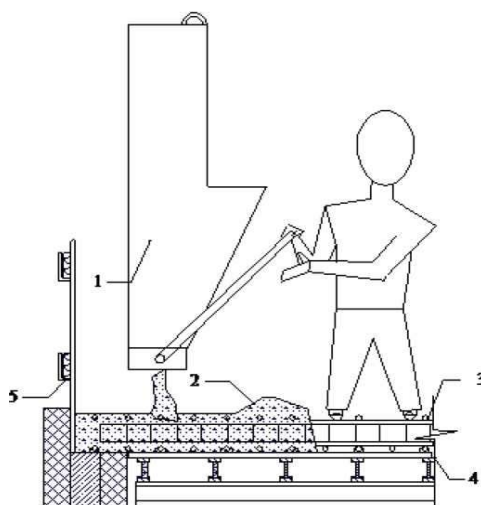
Укладка бетона: 1 - бункер для подачи бетона; 2 - укладываемый бетон; 3 арматурная сетка; 4 конструкция опалубки перекрытия; 5 инвентарное ограждение
